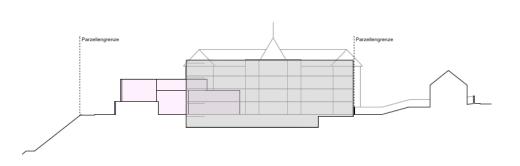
Variante Ersatzneubau Gartenschulhaus – Schnitt A-A
